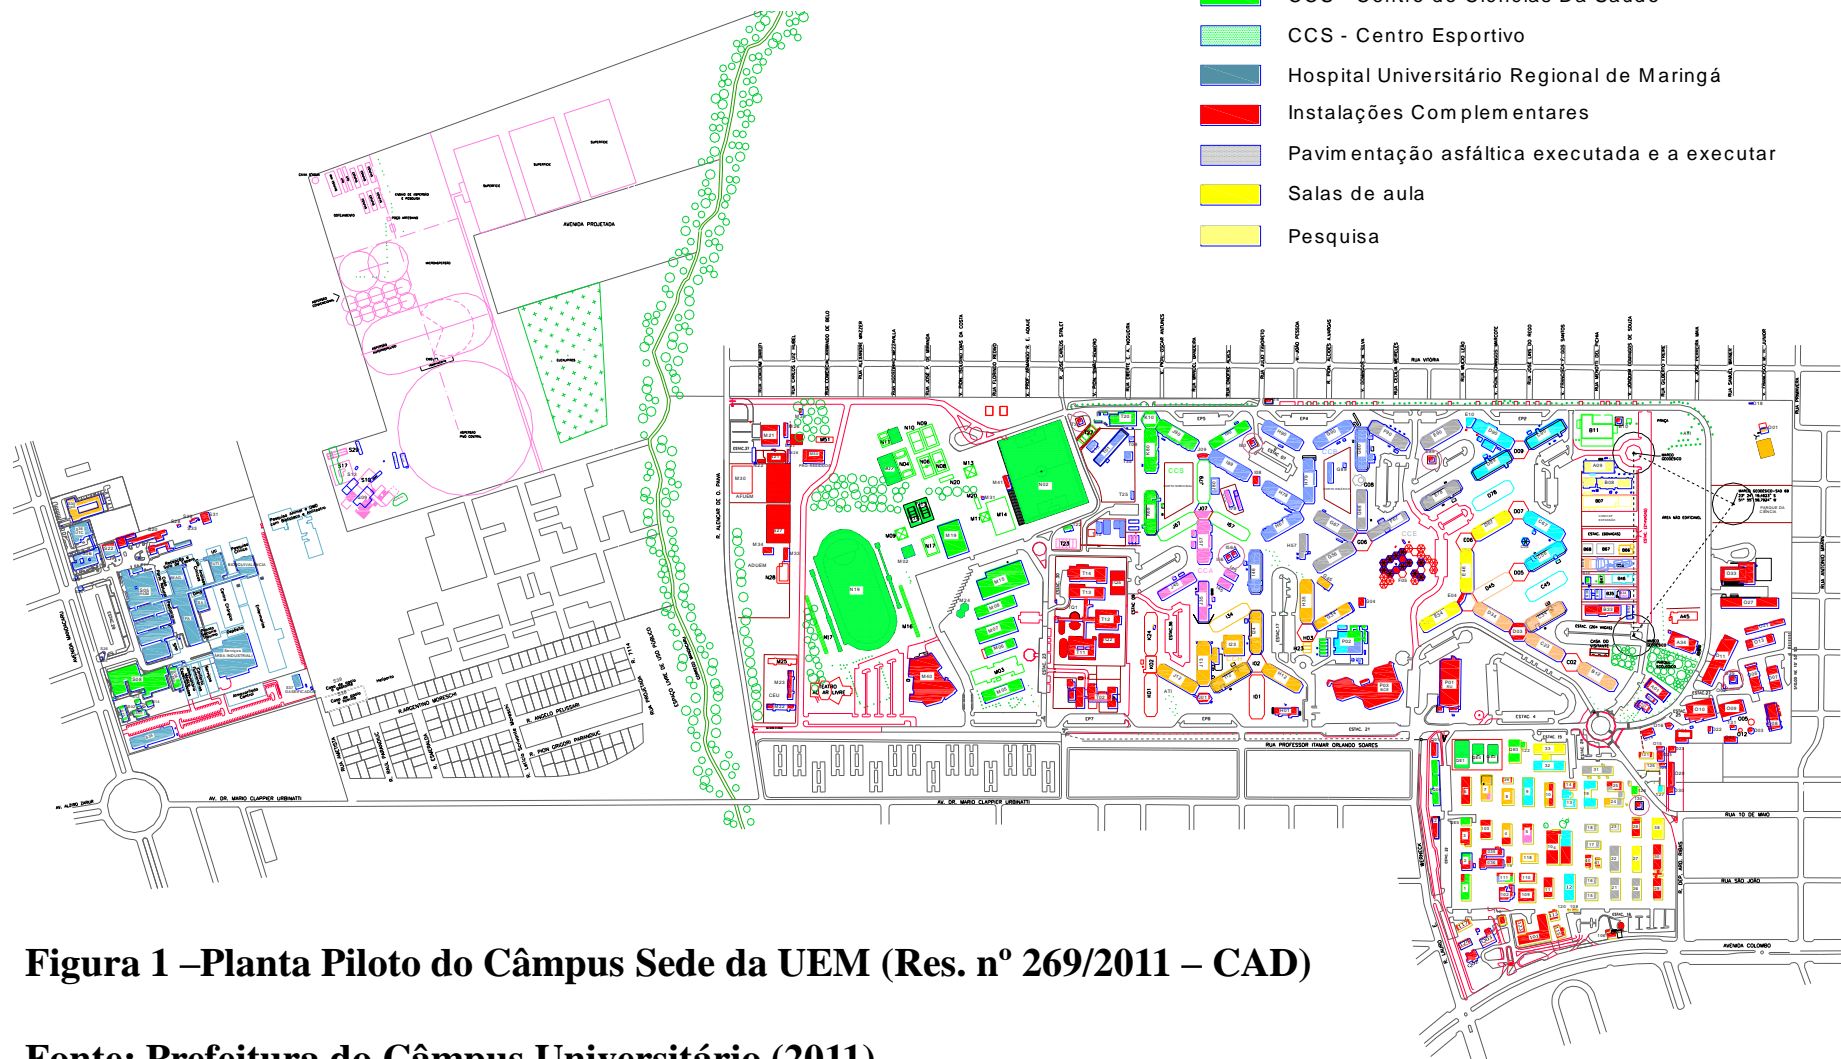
Planta Piloto do Câmpus Sede da UEM (Res. nº 269/2011 – CAD)
